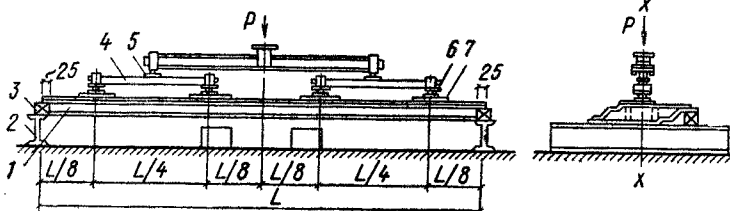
Схема испытания полых асбестоцементных плит на изгиб с помощью сосредоточенных грузов 1 — испытываемая плита; 2 — опоры; 3 — подпорки под верхнюю полку плиты; 4 — траверса; 5 — цилиндрические шарниры; 6 — сферические шарниры; 7 — штамп
